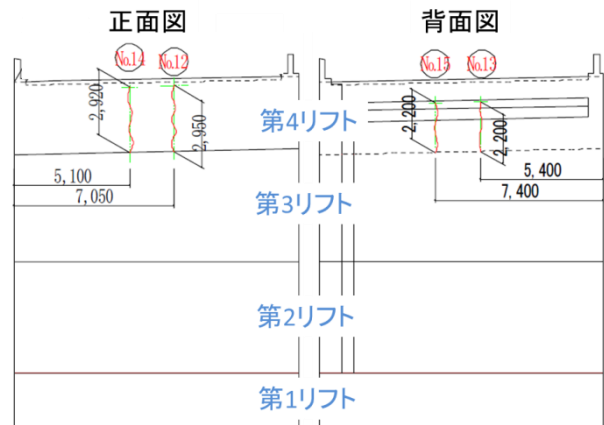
第四リフトのひび割れ状況⁶⁾
